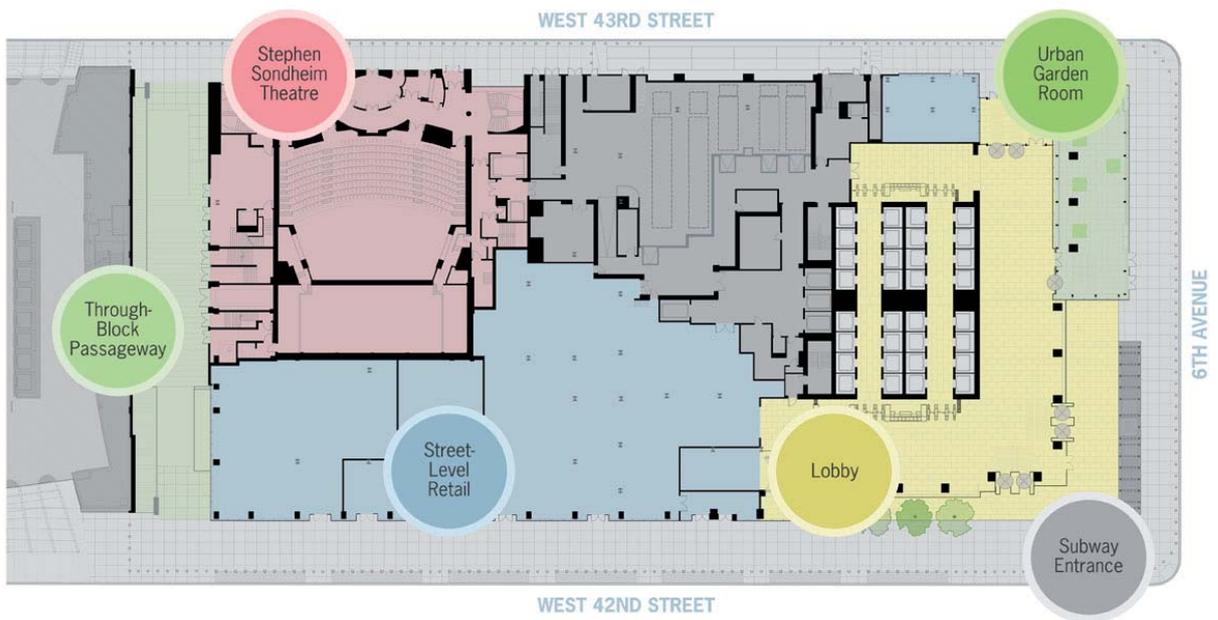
Grundriss Erdgeschoss (Quelle: <http://buildipedia.com>)
